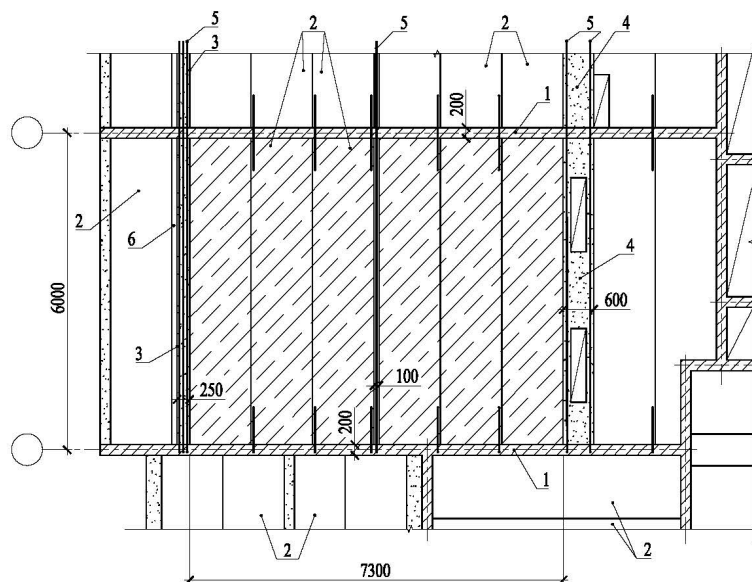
Конструкция испытанного сборно-монолитного перекрытия, опертого на несущие стены в составе здания (нагружаемая ячейка заштрихована): 1 – несущая стена; 2 – сборная многоячеистая плита; 3, 4 – монолитный связевой ригель; 5 – сквозная связевая арматура; 6 – воздушный зазор для размещения утеплителя
